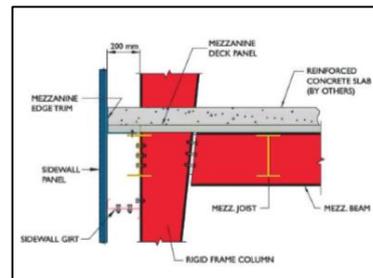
Assemblage poteau-poutre (Source: PRE-ENGINEERED BUILDING-pdf)
